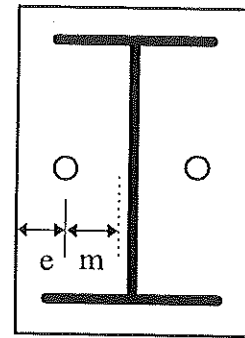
Tiges d'ancrage situées entre les semelles du poteau
